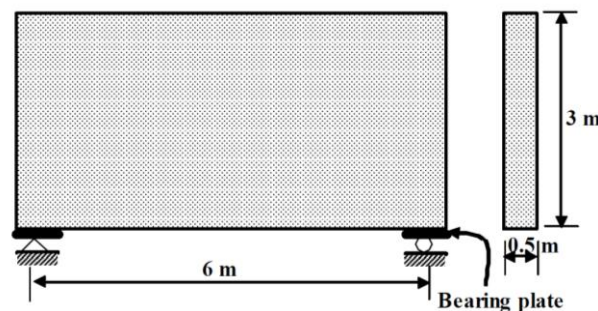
Viga parede bi-apoiada (Nagarajan et al., 2009).
